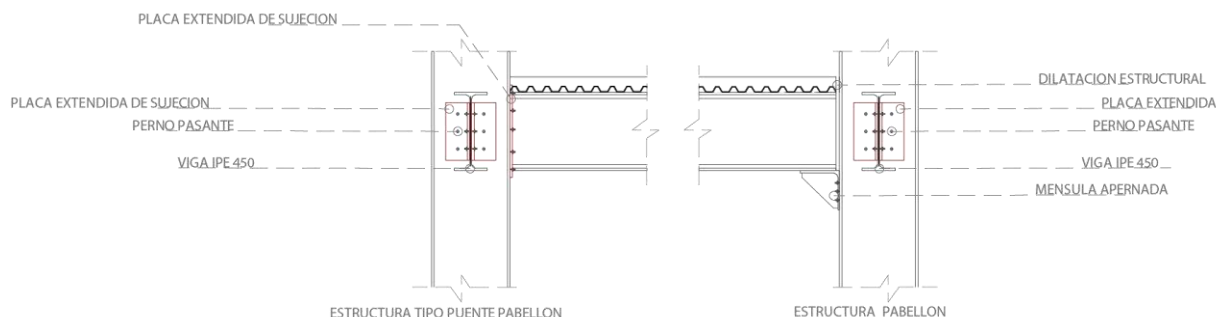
Detalle Unión Viga Concreto – Viga IPE
